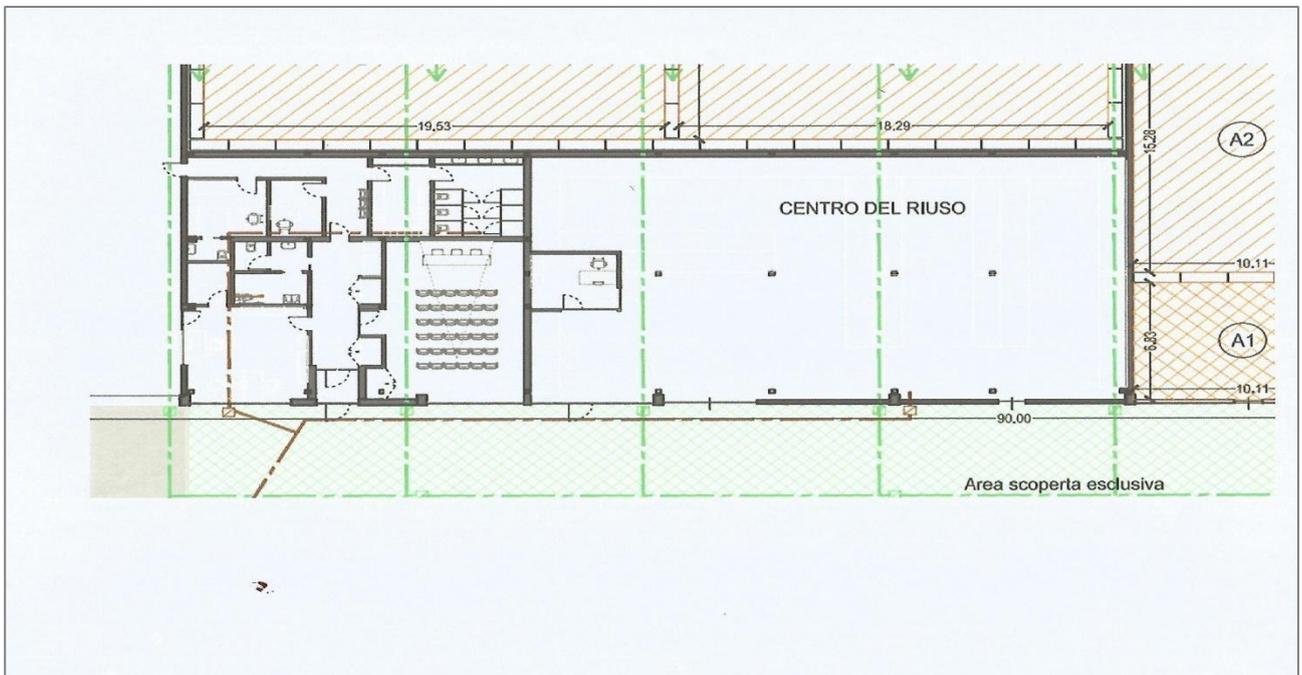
La planimetria del sito e dell'area circostante della futura sede del Banco del riuso.
